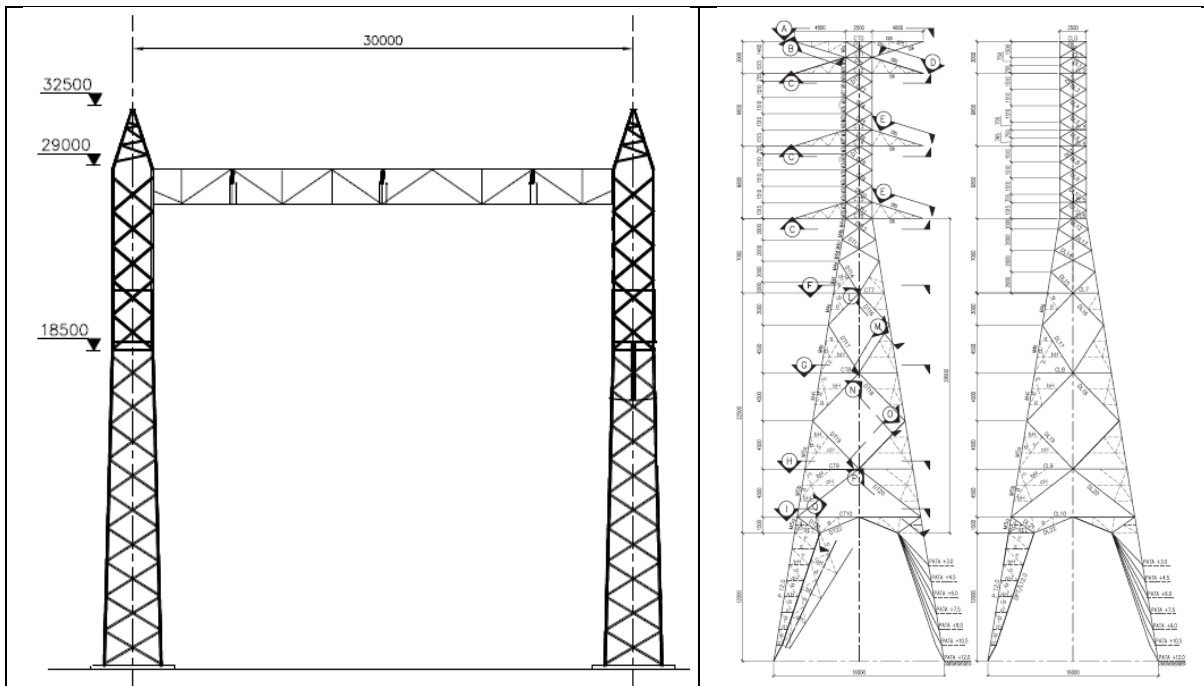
Tipo de estructuras de soporte a instalar en el proyecto
